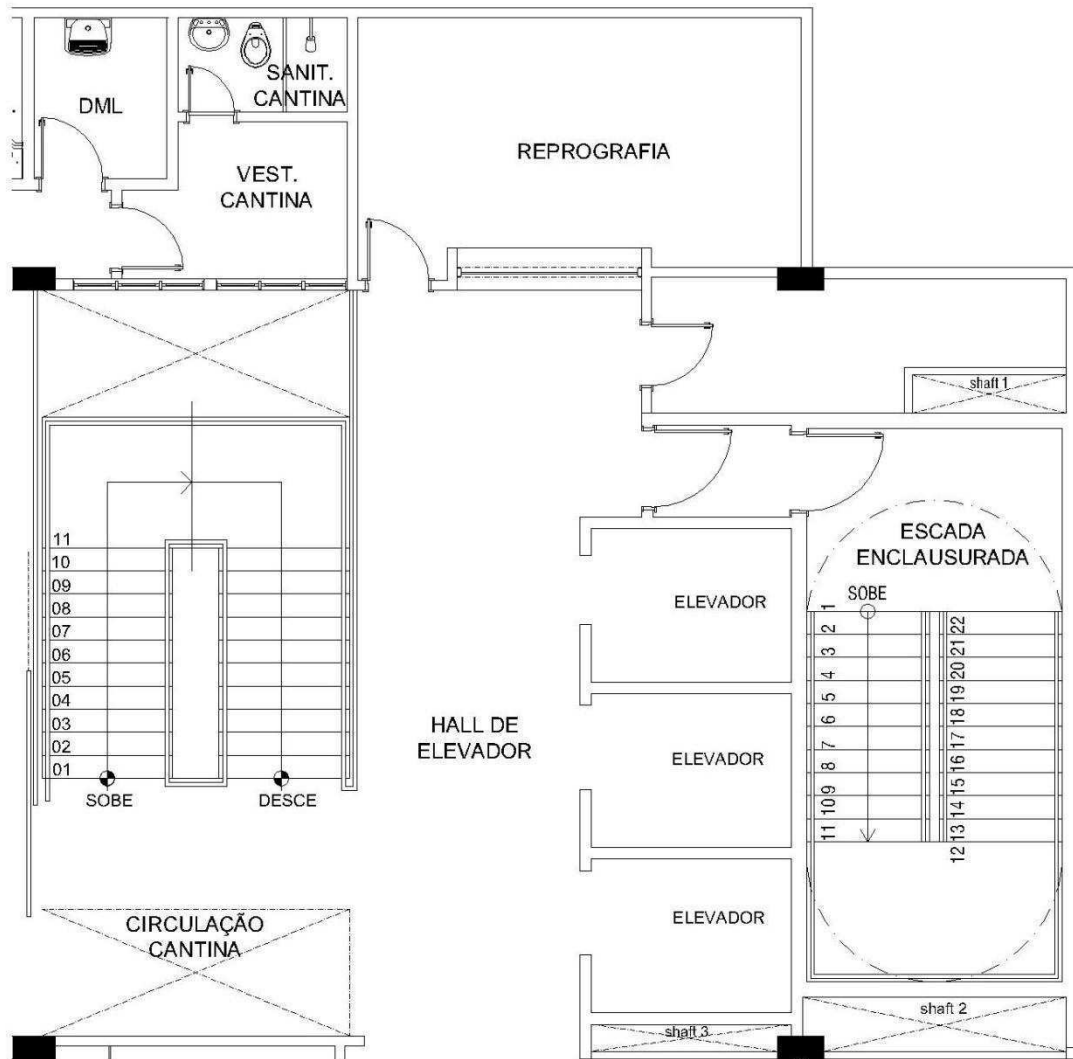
Planta baixa parcial do 2º Pavimento – Hall de acesso, Reprografia.
